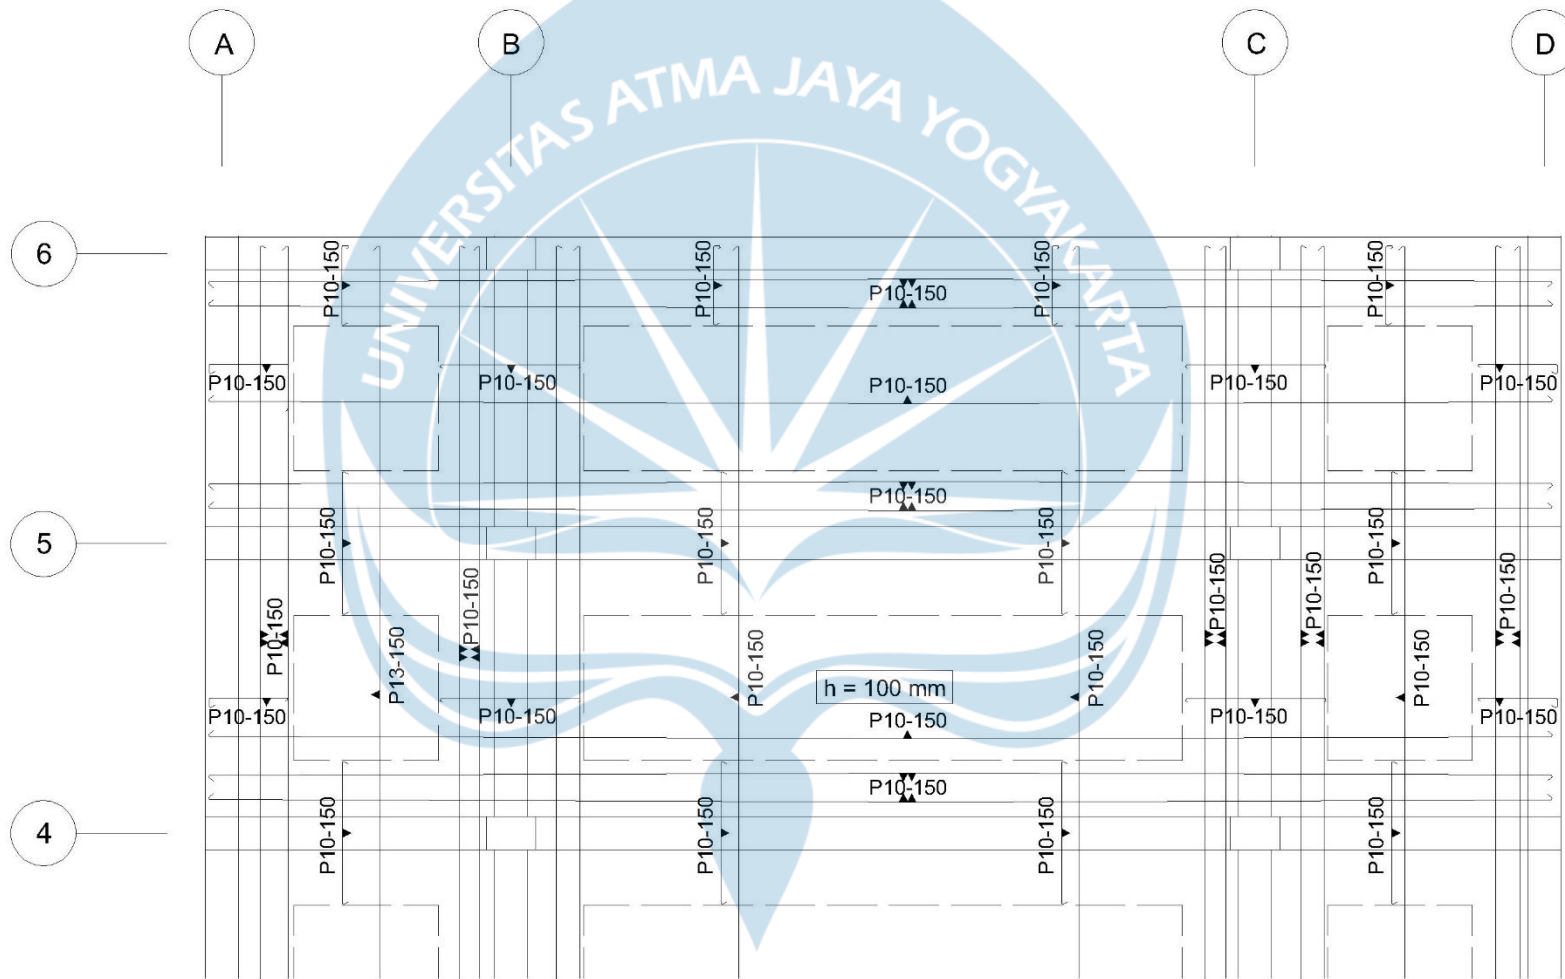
Denah pelat lantai pada aplikasi ETABS
